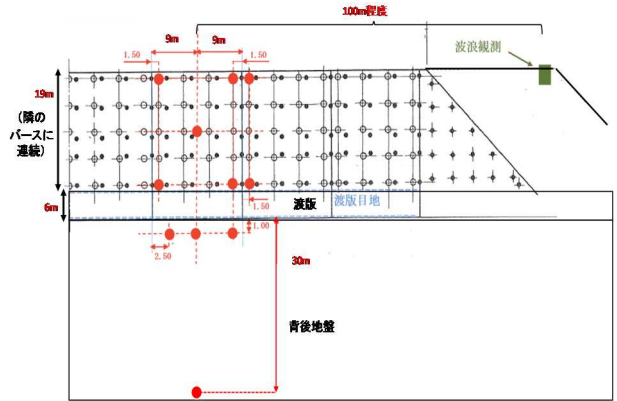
棧橋の平面図（赤丸が微動計の設置位置）
